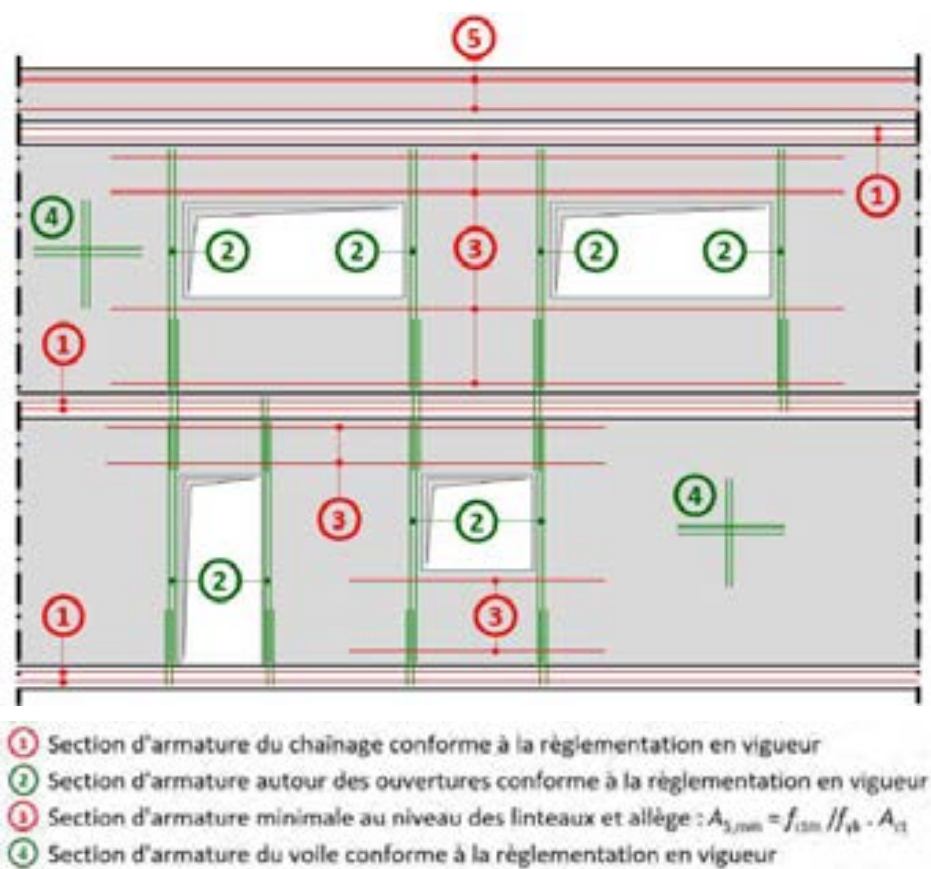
Dispositions des armatures de renfort dans les voiles en béton armé
